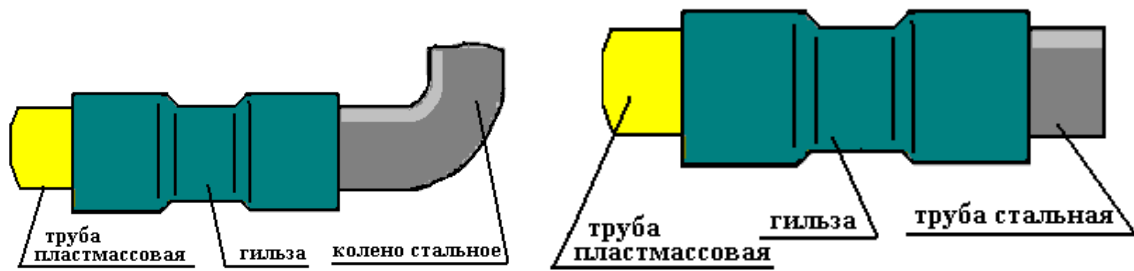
Соединение неметаллических труб при скрытой прокладке
